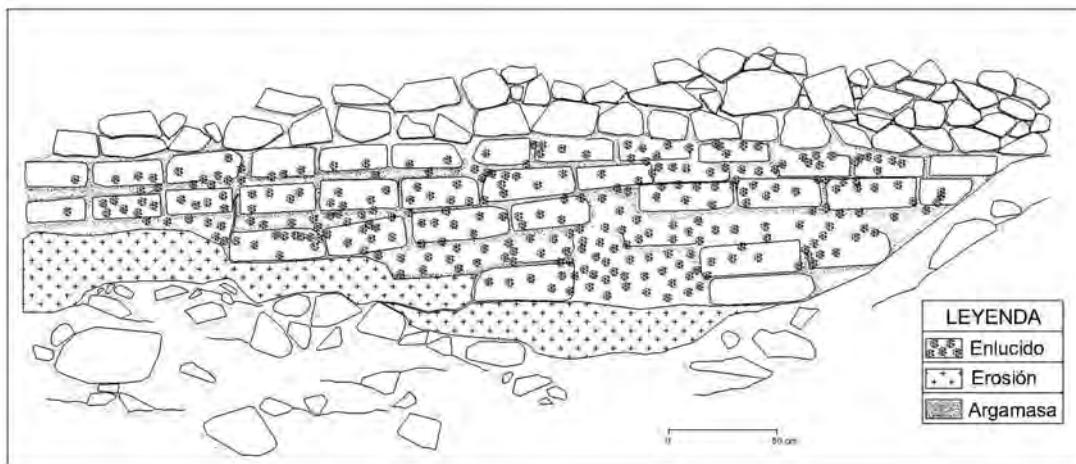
Detalle de muro norte de adobes con hornacina cuadrangular. (Sitio 8-Ollería).
